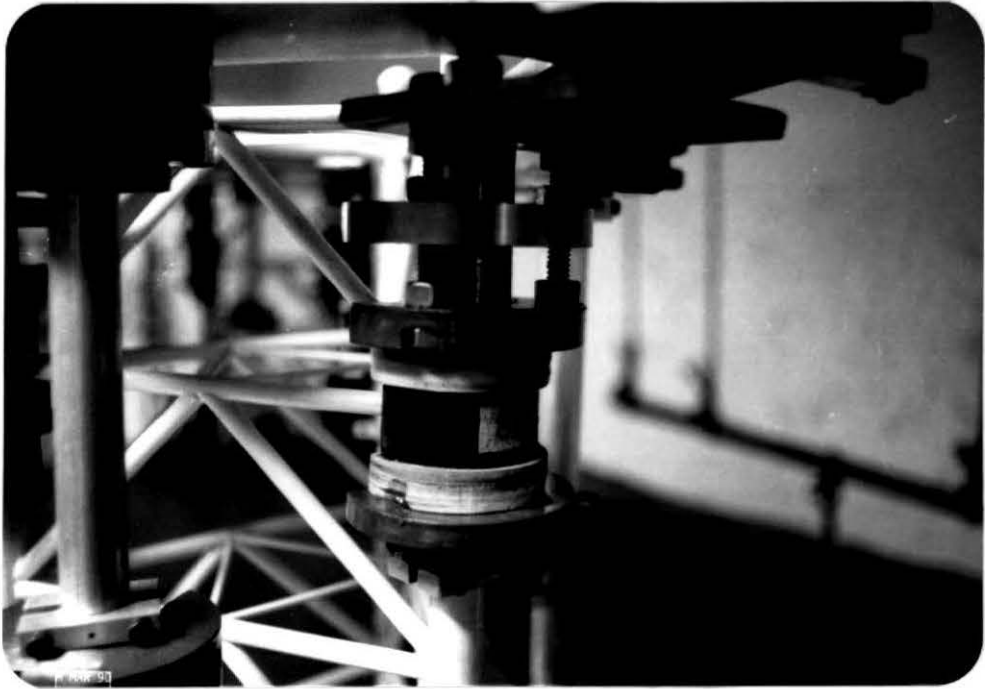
Detalhe do Apoio Elástico/Amortecedor entre Convês e Perna
